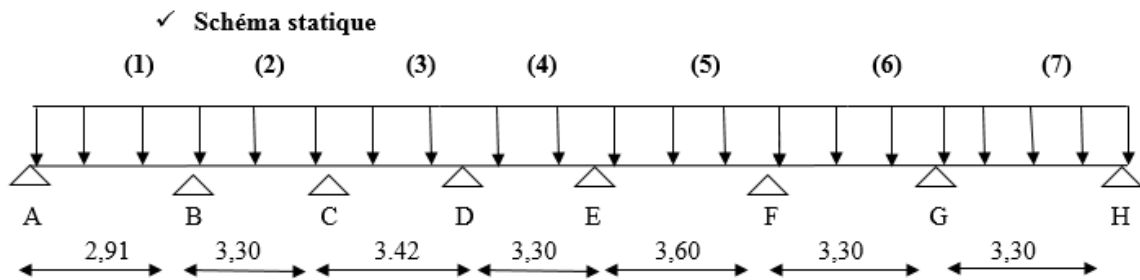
schéma statique de l'ensemble des poutrelles
